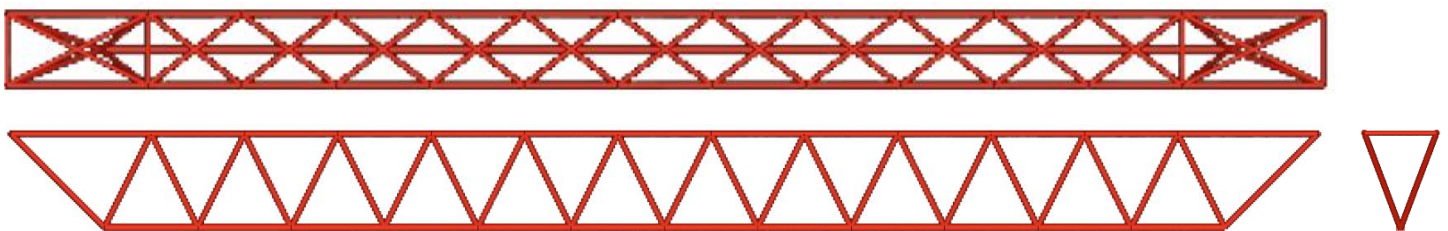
VISTAS DE LA CELOSÍA DE LA VIGA. ARRIBA LA PLANTA, ABAJO A LA IZQUIERDA EL ALZADO Y A LA DERECHA EL PERFIL
